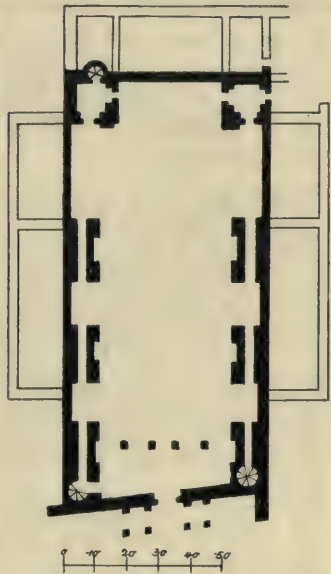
Douai. Jesuitenkirche. Grundriß und Erweiterungsplan.
